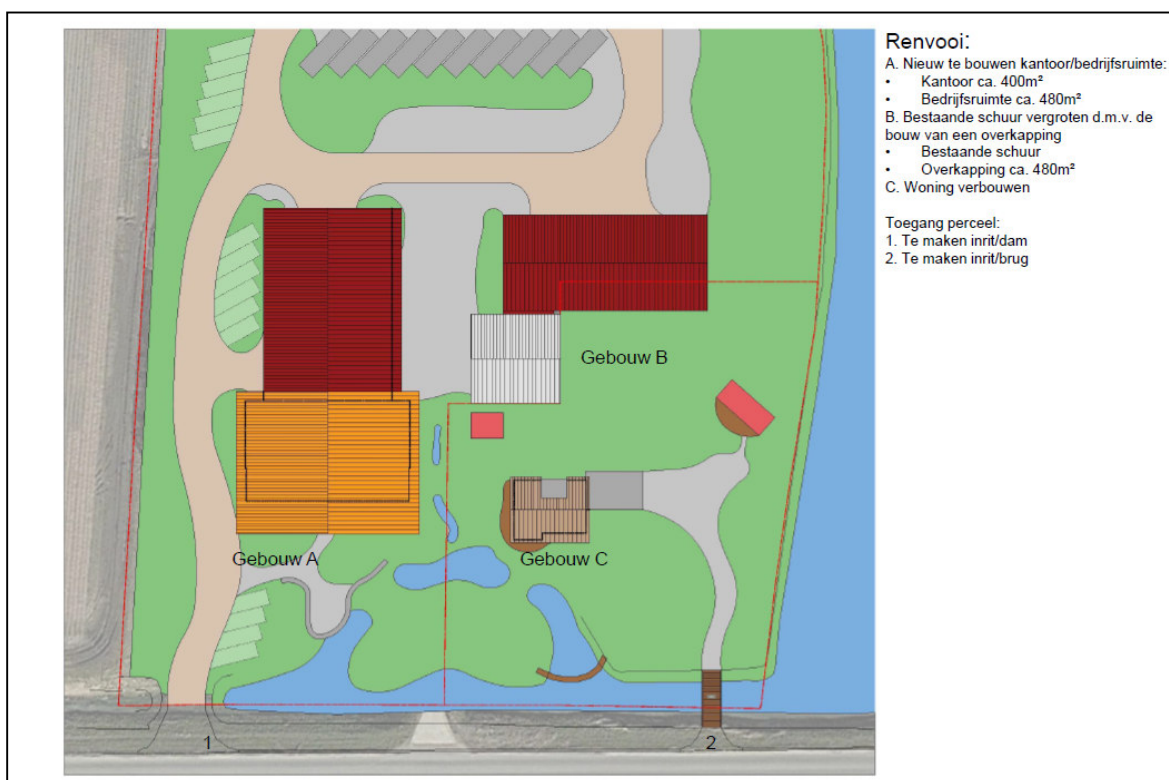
Situering planlocatie voor Geerling 20 in Grootebroek
